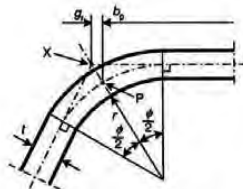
Determinazione del punto X per la valutazione della larghezza di elementi piani
